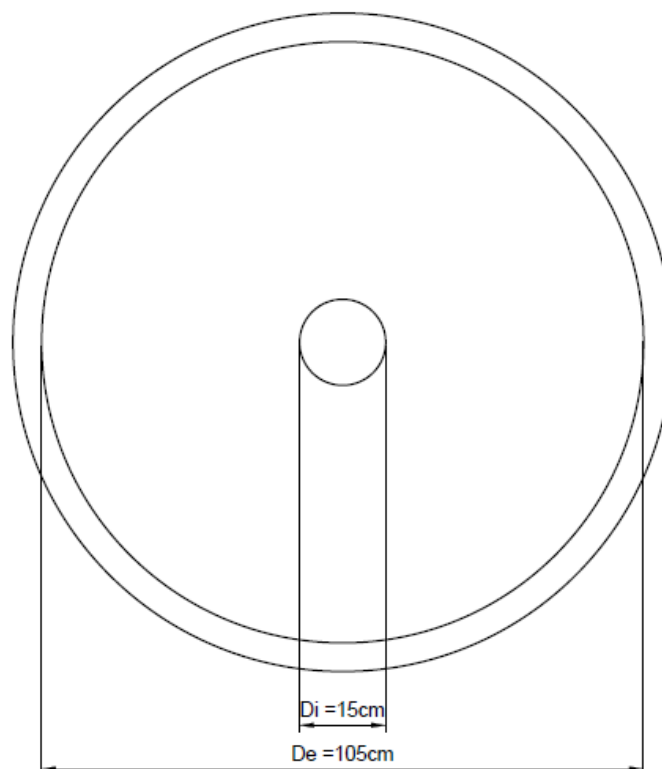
Esquema de configuración del Aislador HDR - Planta
